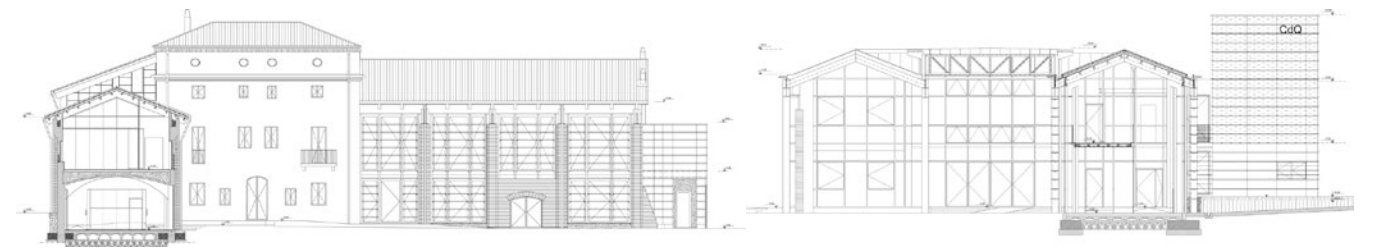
Sección transversal, alzado Noreste (izq.) y sección transversal, alzado Suroeste (der.).
